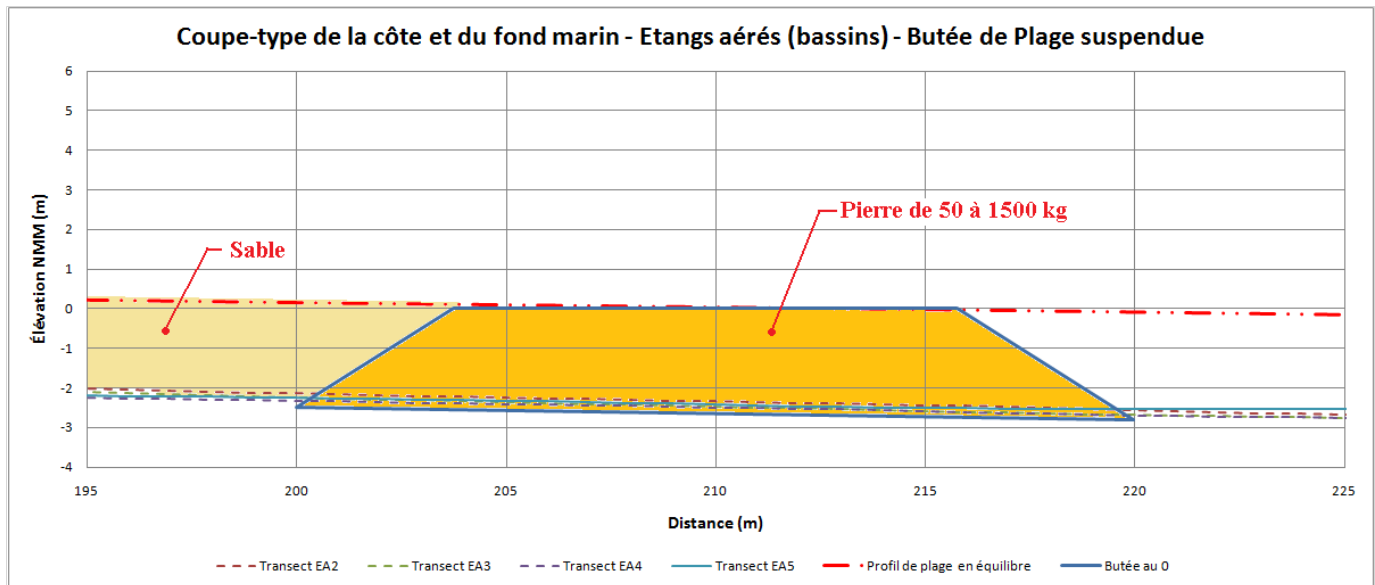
Coupe type d'une butée de pied de plage suspendue en enrochement au zéro NMM
